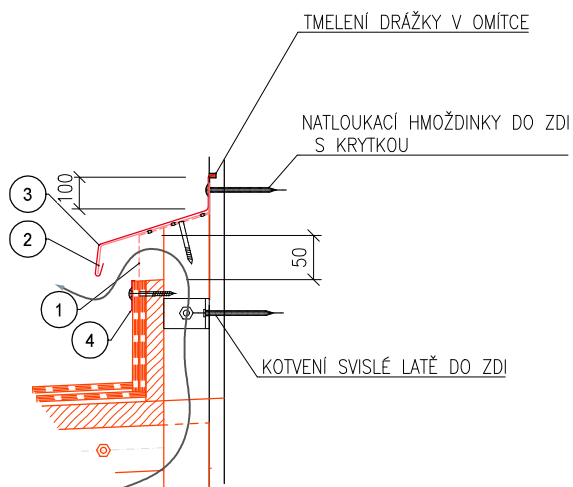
ZÁVĚTRNÁ LIŠTA, M 1:10
